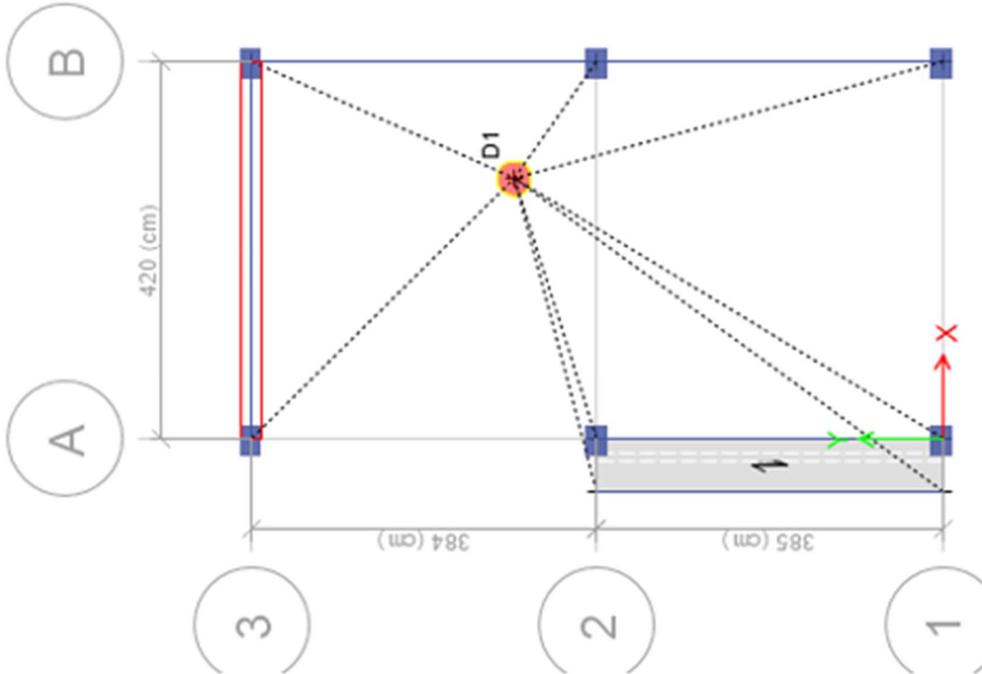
ETABS, Secciones de Vigas y Columnas en Pórticos Secundarios
